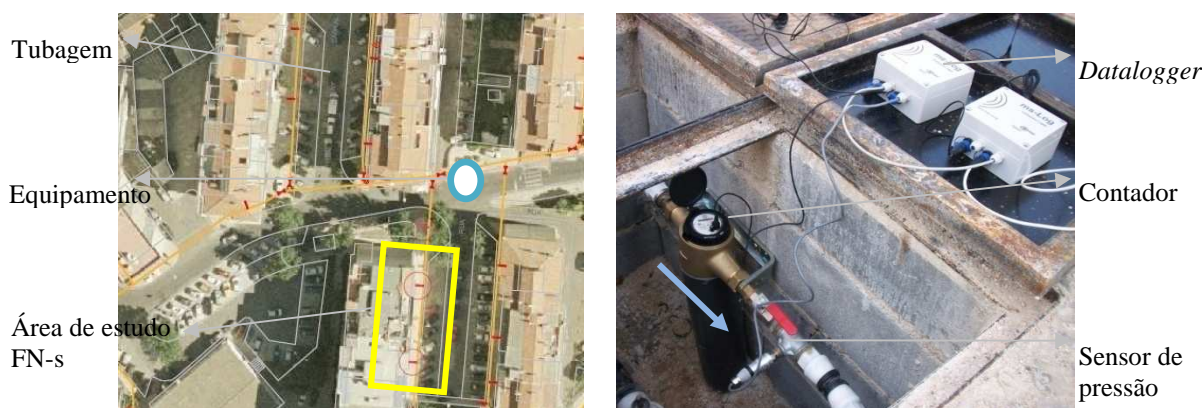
Área de estudo FN-s: a) localização do equipamento, b) equipamento instalado na pré-campanha.
